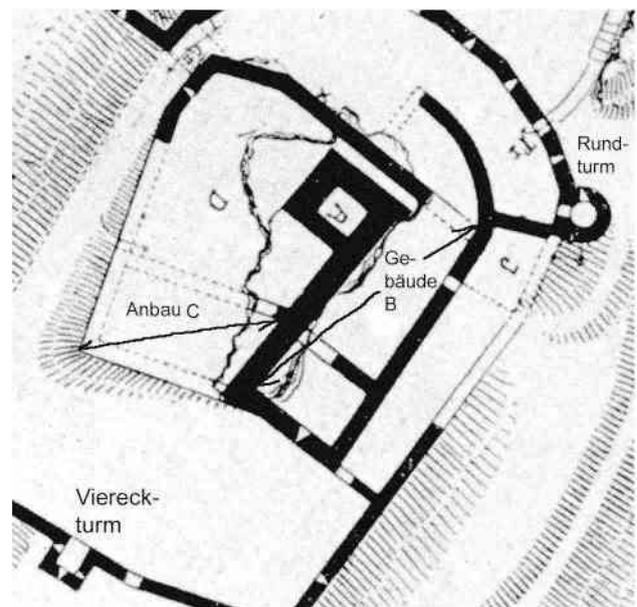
Der Grundriss von Koch passend zur obigen Abbildung gedreht.
